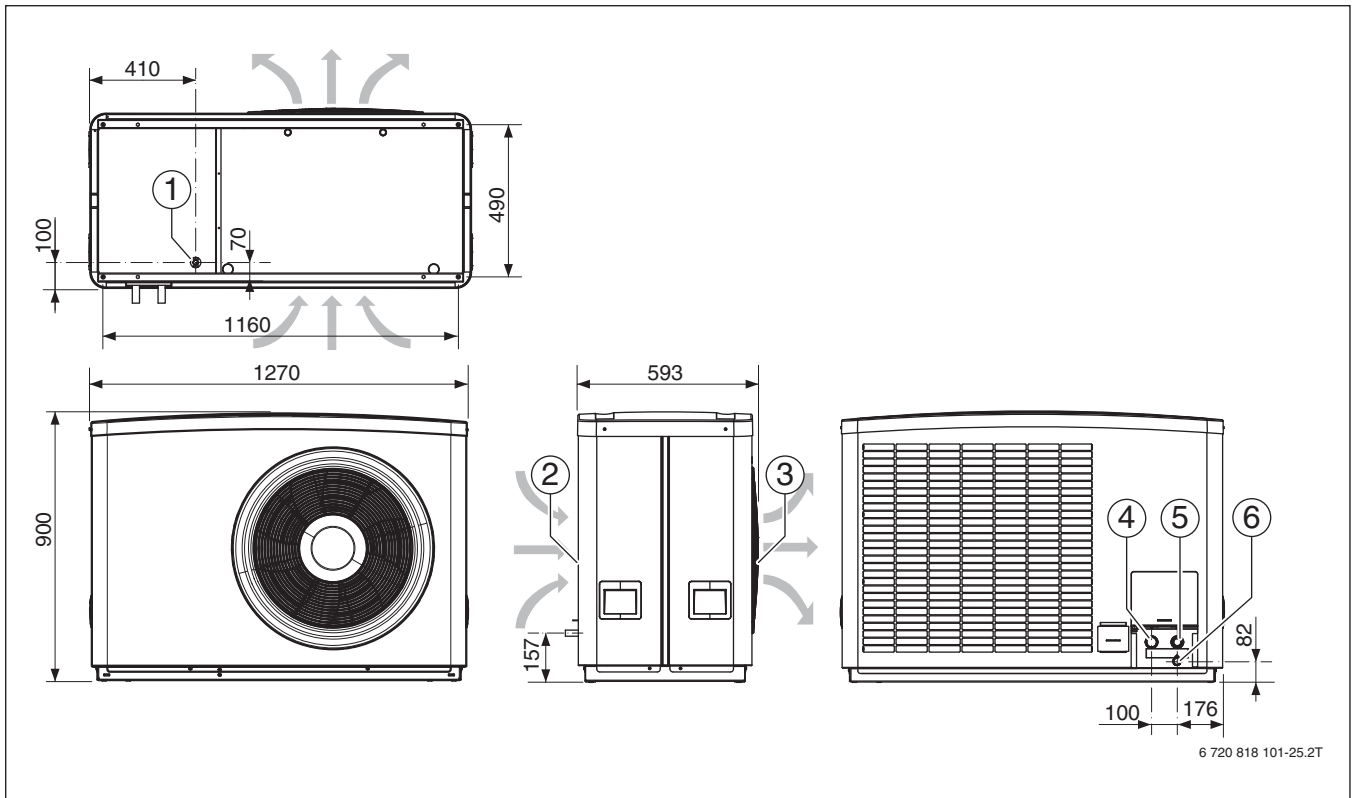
Abmessungen und Anschlüsse SAO 90-2 HT
